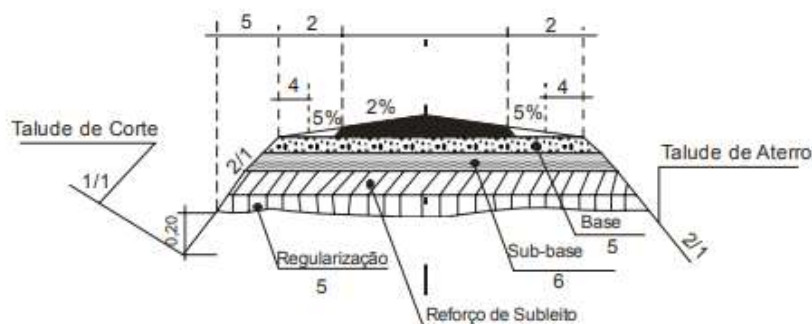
Esquema de seção transversal do pavimento (Fonte: Manual de pavimentação - DNIT).
